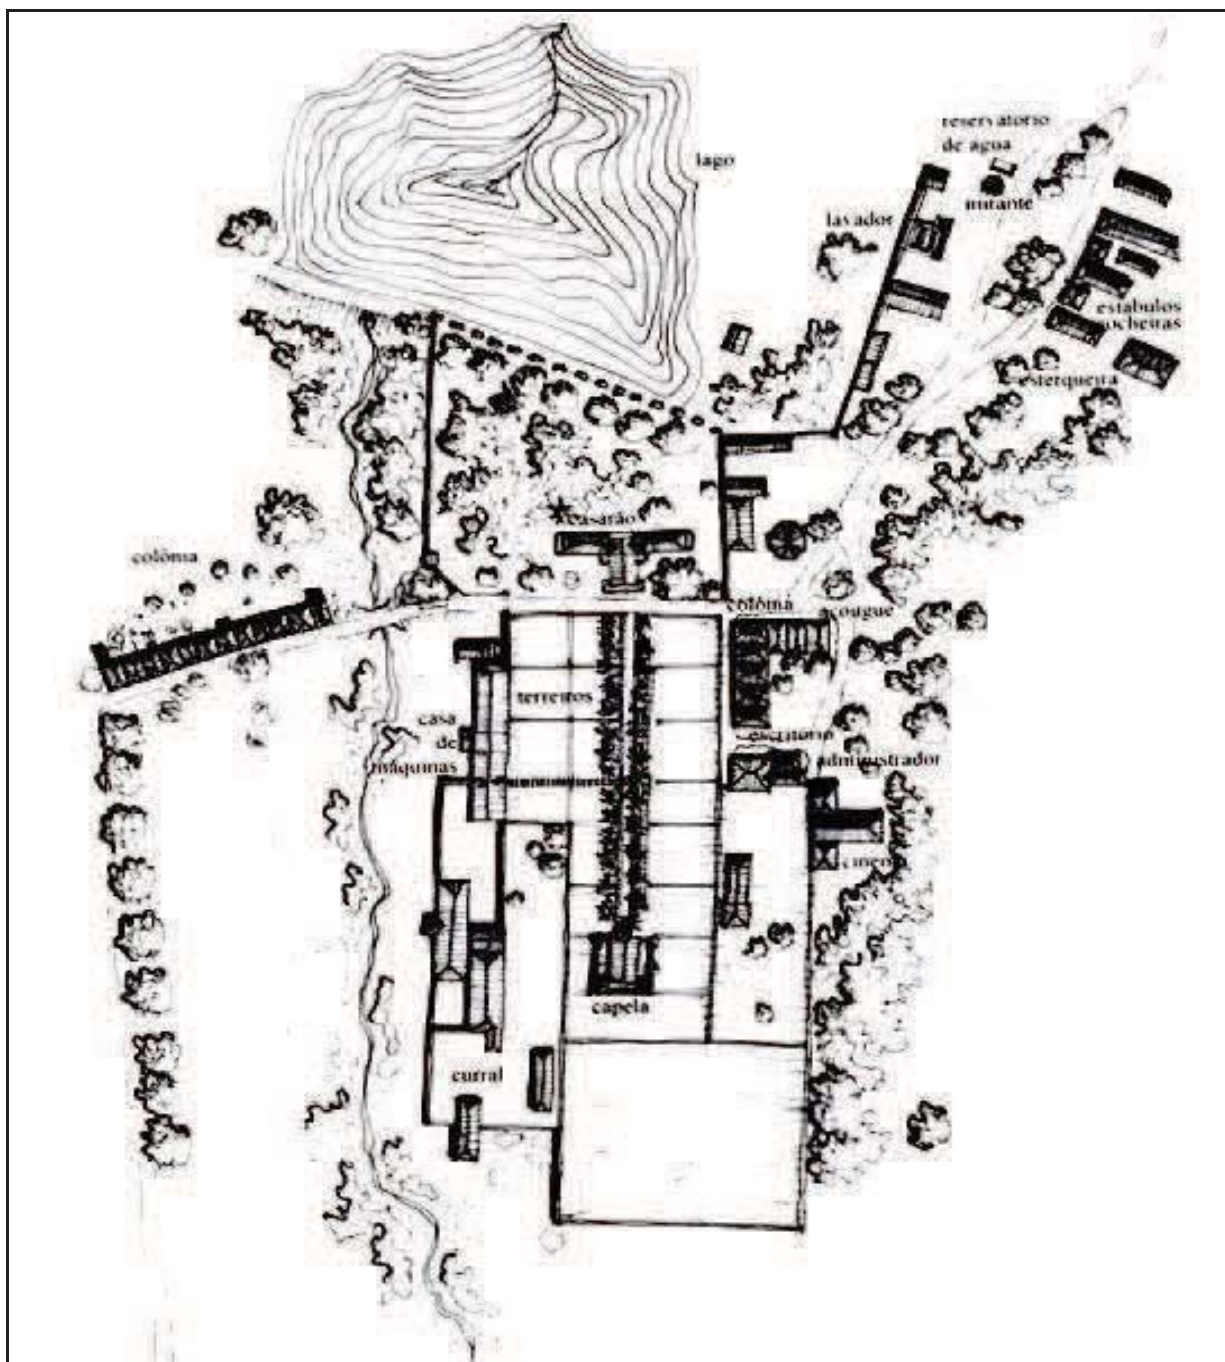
Implantação da fazenda Santa Gertrudes século XX..
